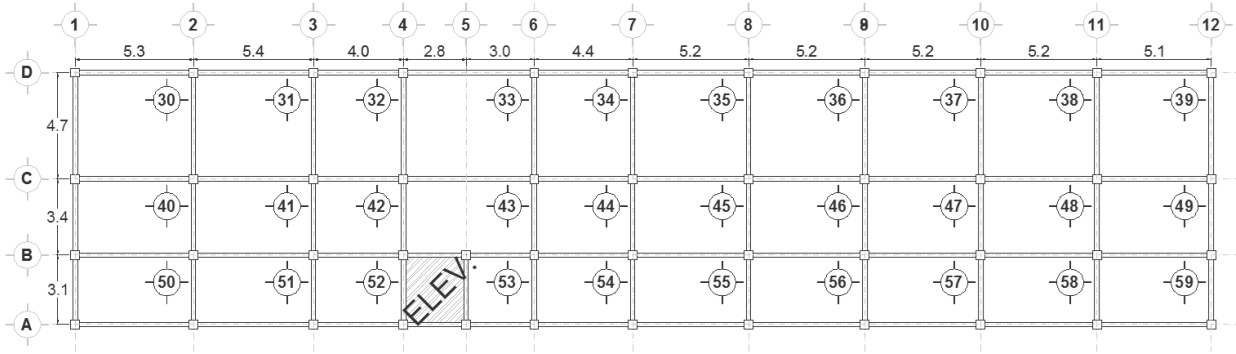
Vista en planta de losas de segundo nivel.
